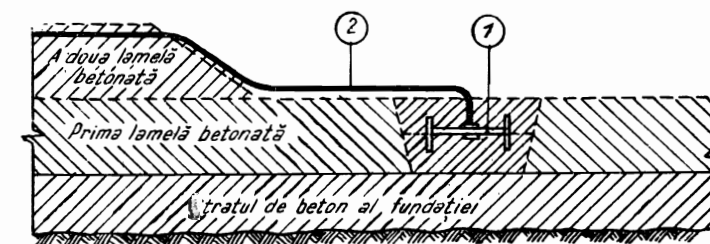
Schema de instalare a tensometrului electroacustic în beton.
